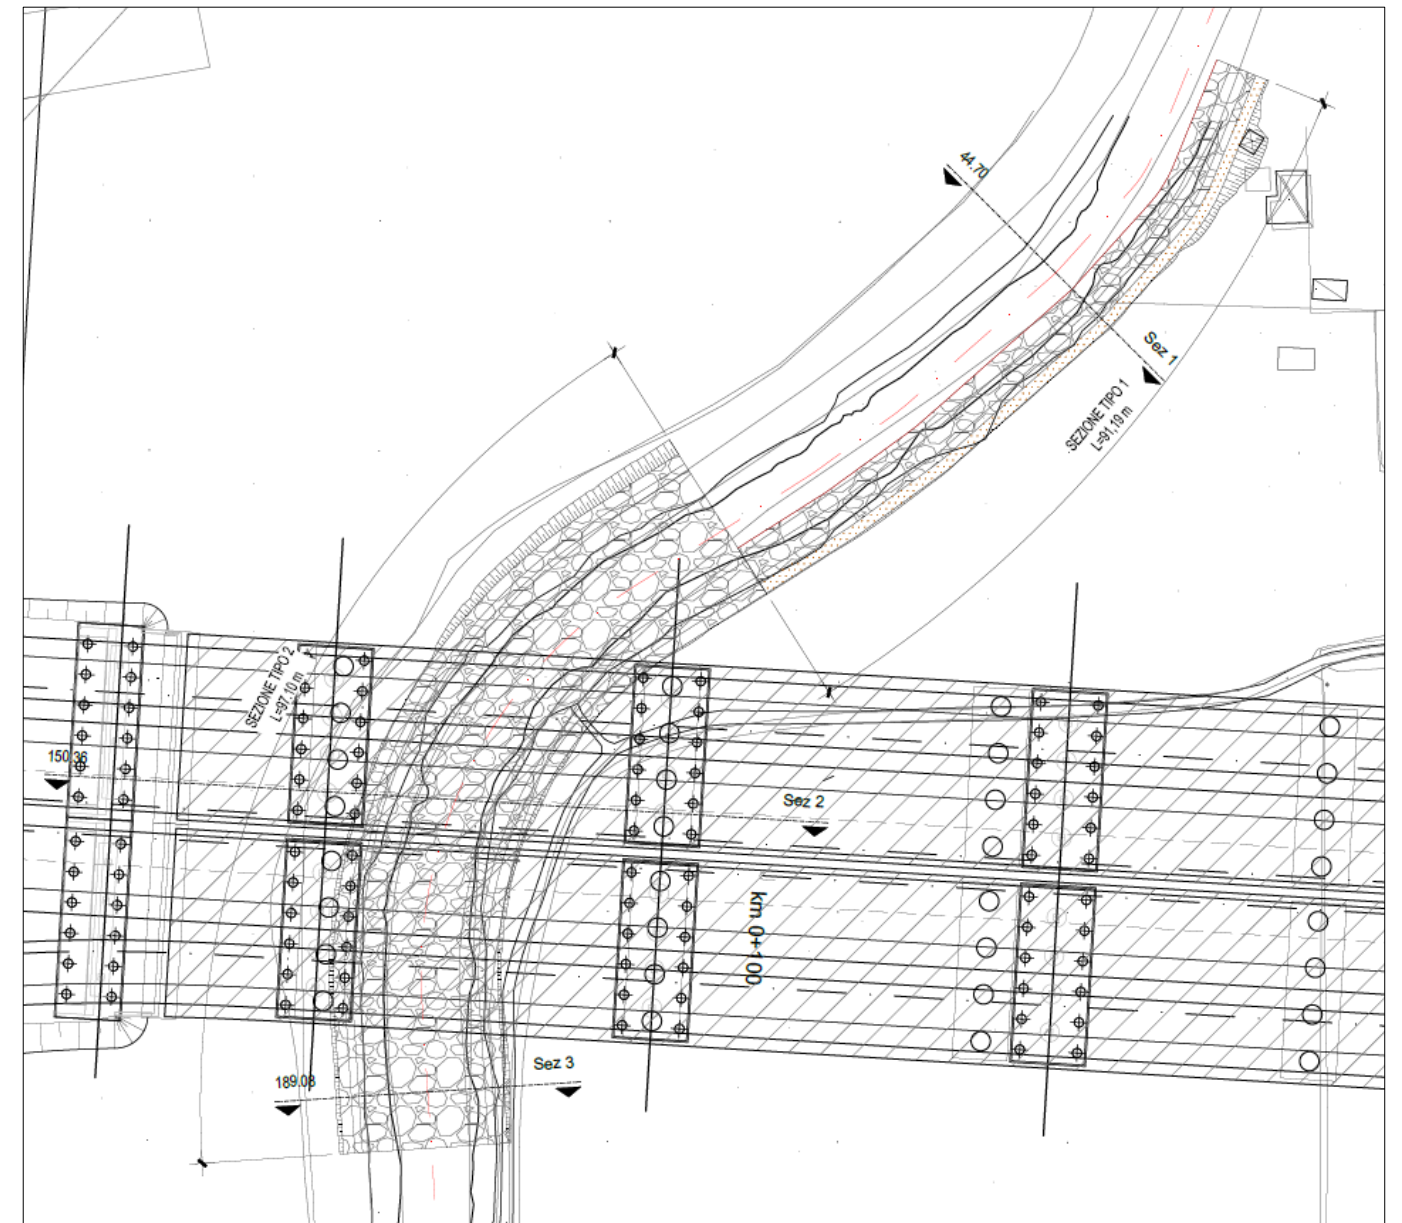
Planimetria delle opere di sistemazione idraulica.
